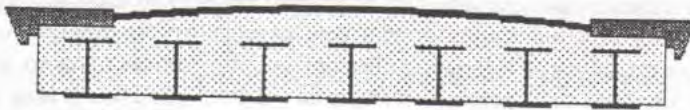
Coupe schématique d'un pont à poutrelles enrobées.
